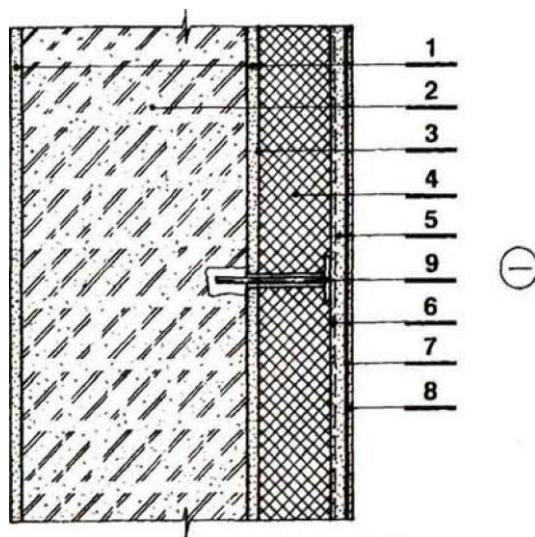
Структура теплоэффективной наружной стены в виде фасадной теплоизоляции с оштукатуриванием по сетке: 1 - отделка внутренней поверхности стены; 2 - стеновая ограждающая конструкция (керамзитобетонная панель); 3 - крепление теплоизоляции (клеевой состав); 4 - теплоизоляция; 5 выравнивающий слой штукатурки; 6 - армирующая стекловолоконная сетка; 7 – грунтовка выравнивающего слоя под декоративный; 8 - декоративно-штукатурный слой; 9– анкерные дюбель
